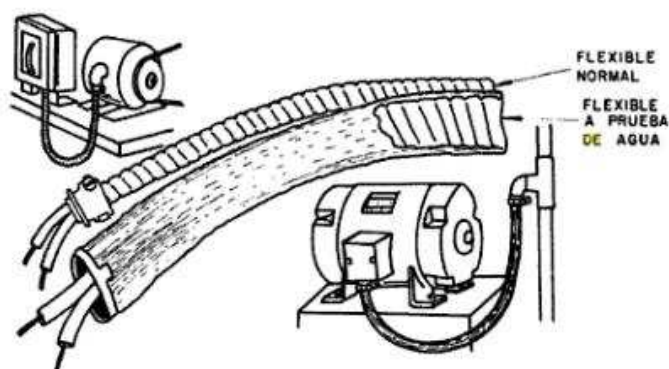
Tubo conduit flexible usado para conexión de motores
